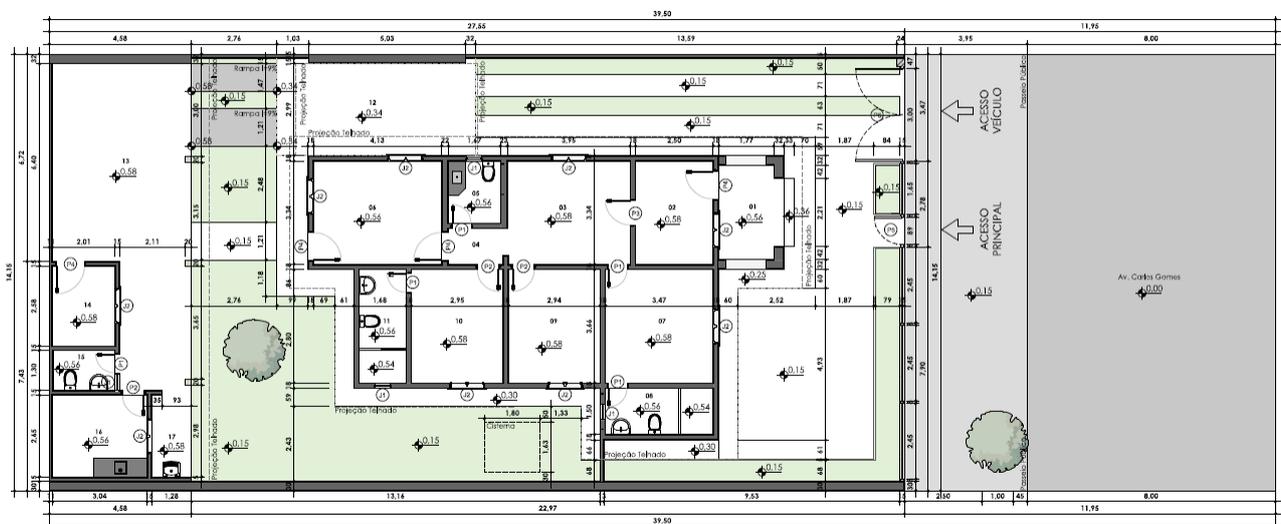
Edificação em 2024 após a requalificação proposta pela autora.
